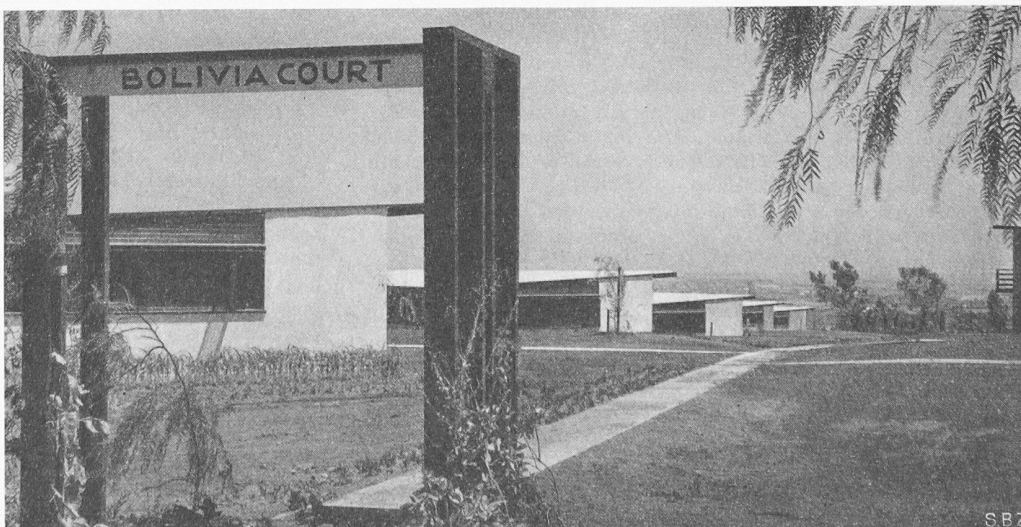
Eingangspforte und Fusswege zu einer Gruppe von Vierzimmerhäusern
